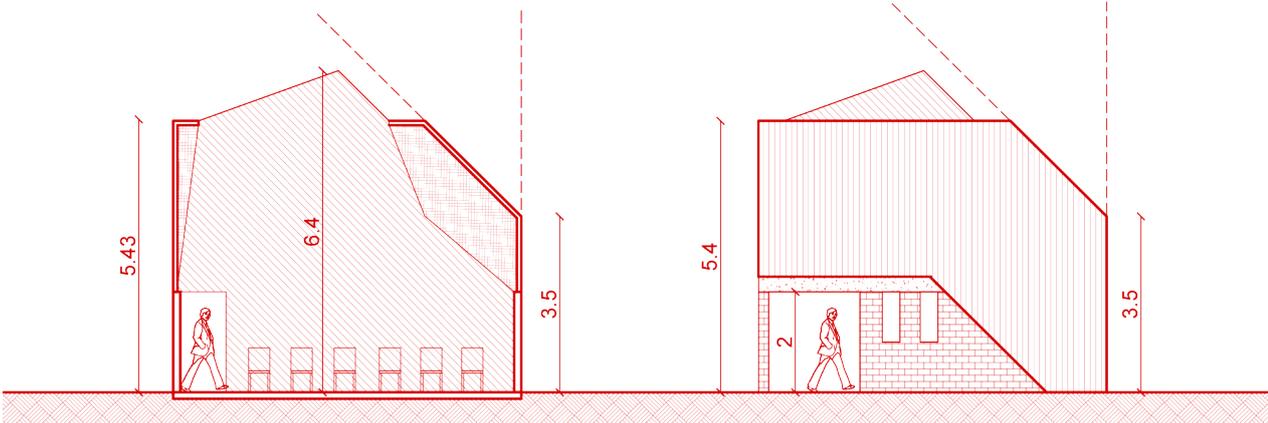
Planimetría Propuesta, lugar de culto. Caso 01
